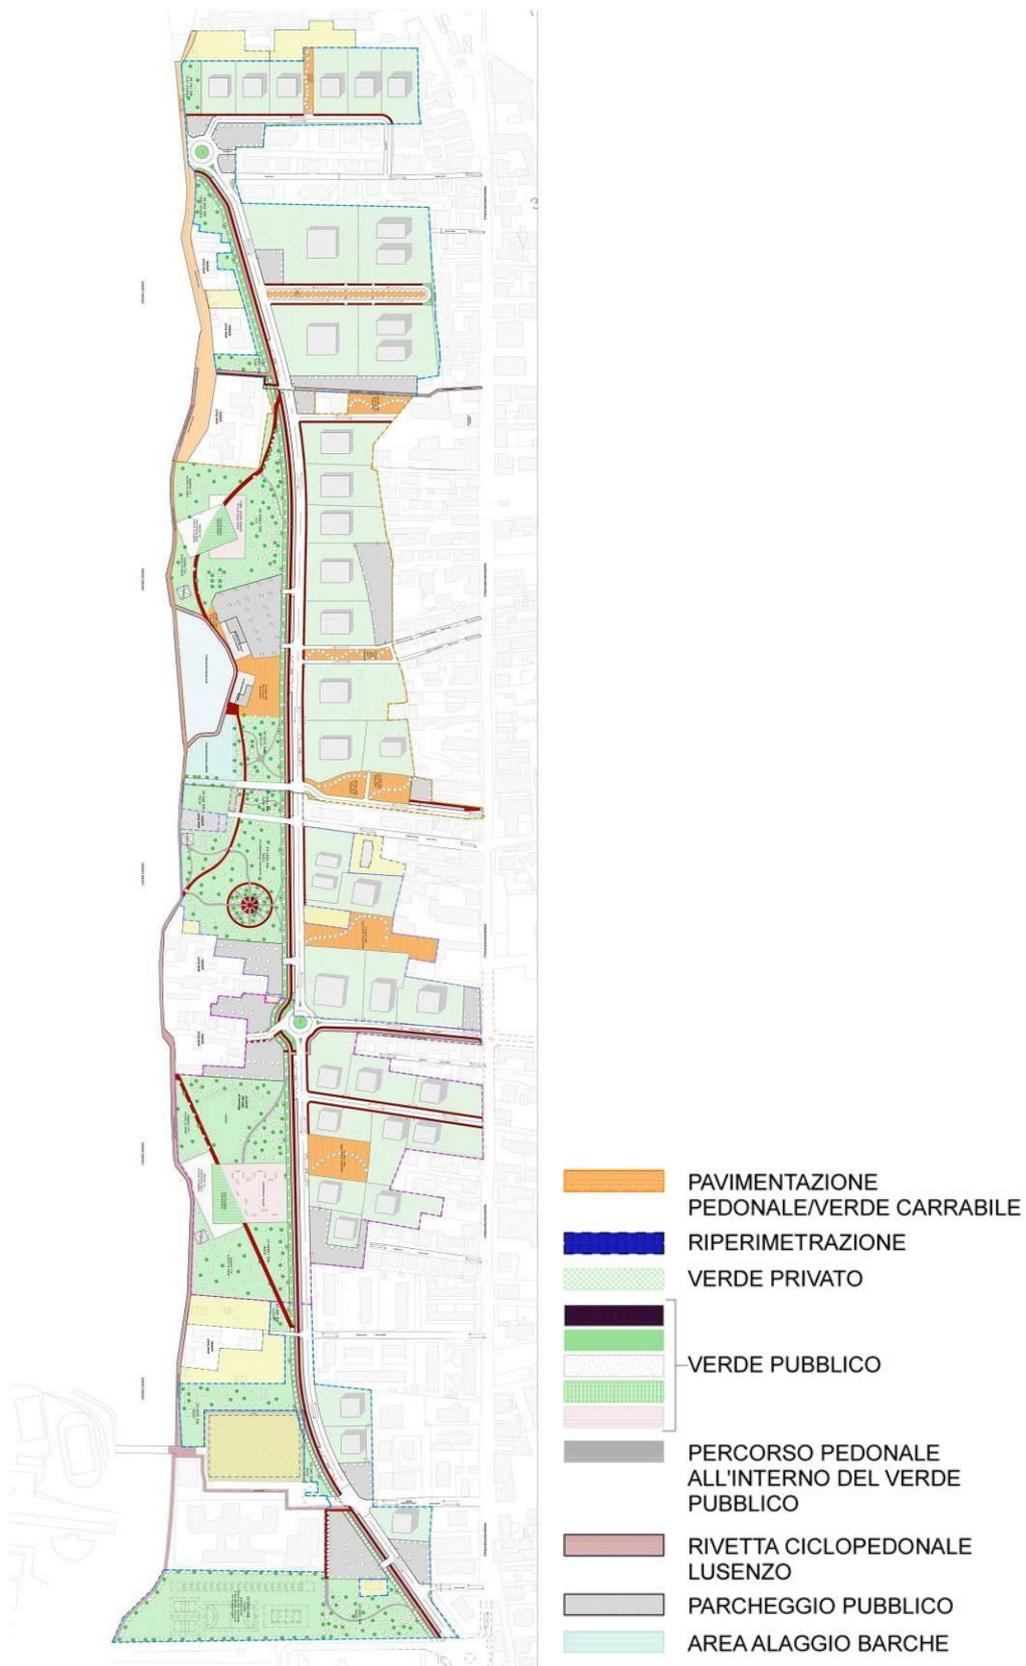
PLANIVOLUMETRICO DEL PROGETTO
